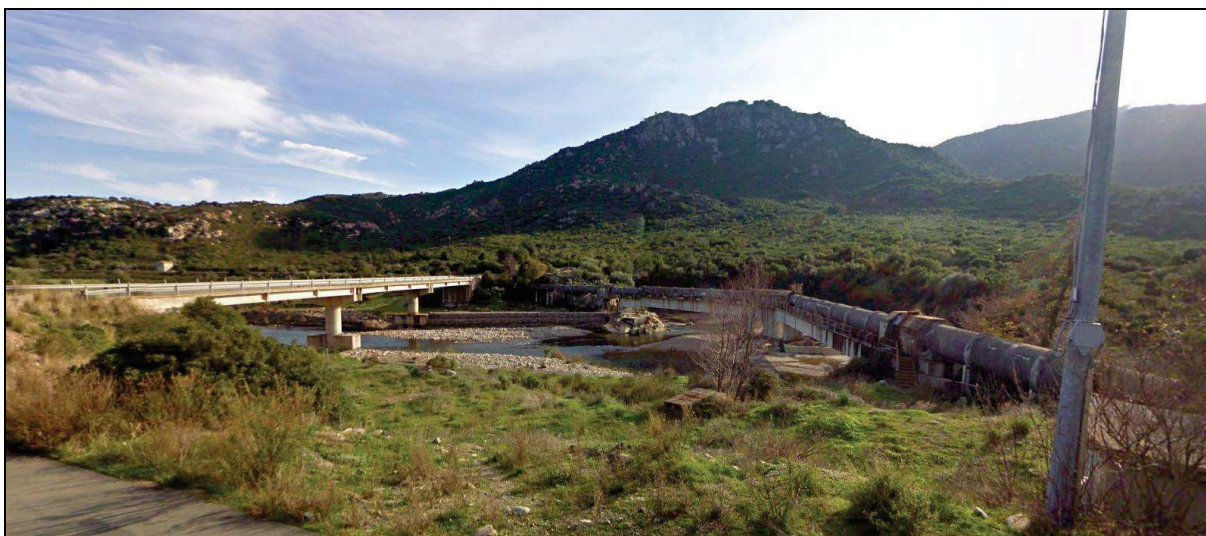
Ponte canale e ponte su strada consorziale Tradalla
